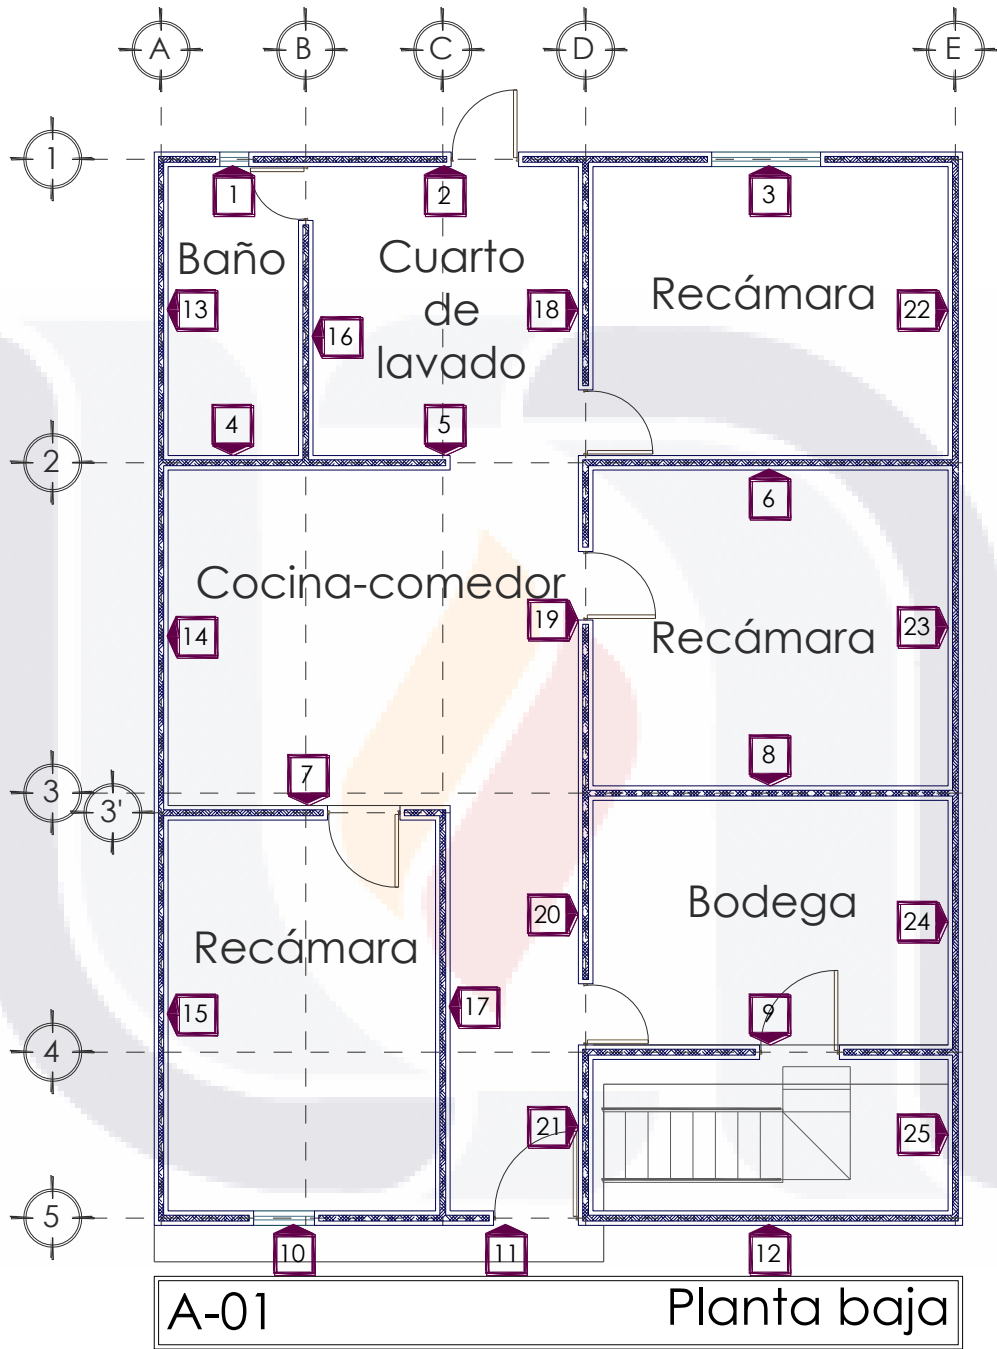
Caras de muros consideradas en el análisis. Planta baja
